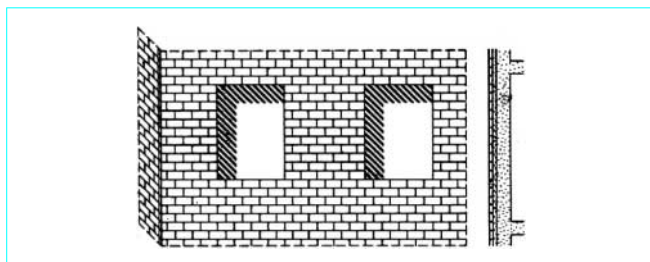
Revêtement collé (appareillage en format 30 × 15 cm)
